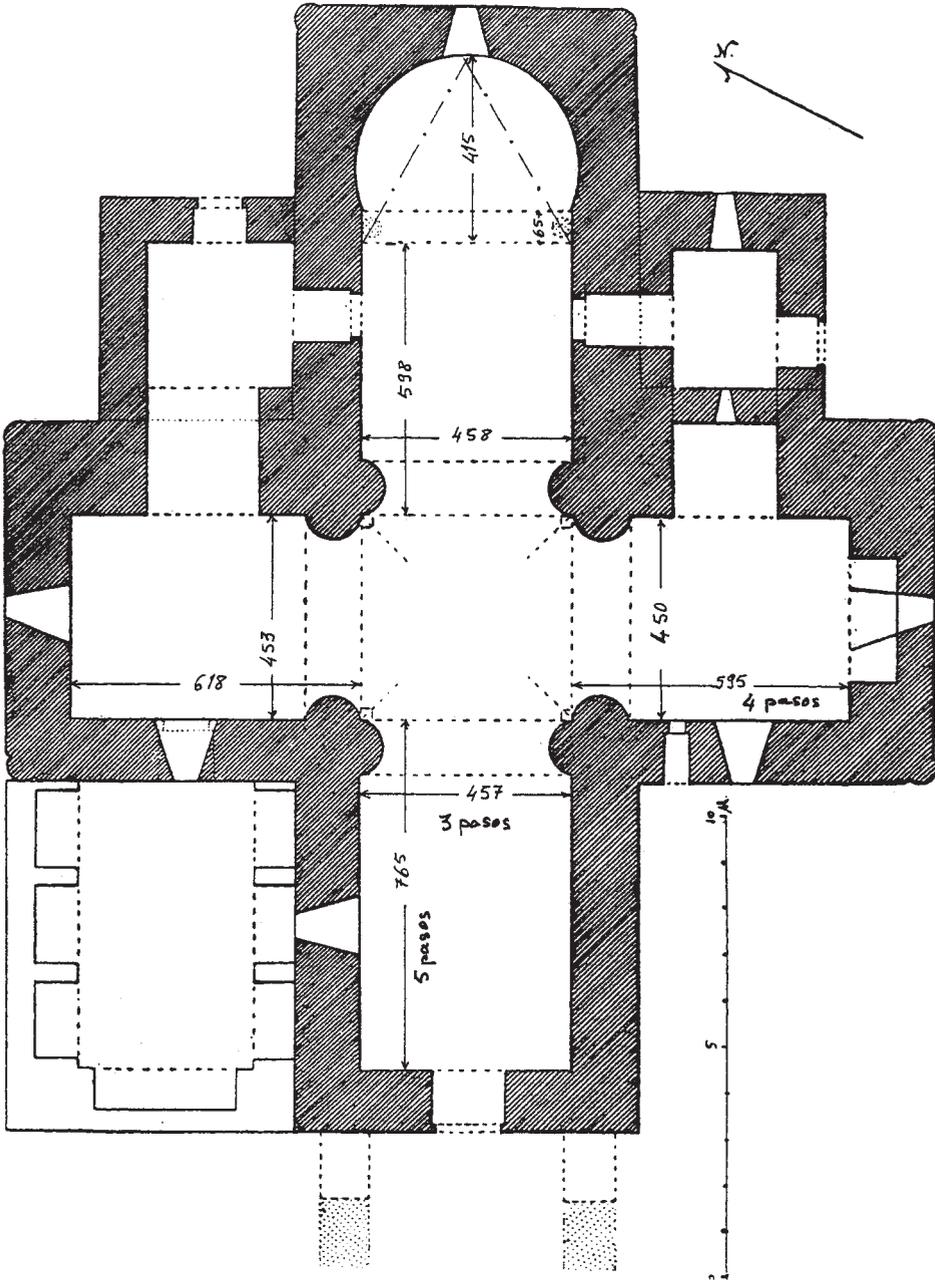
Santa María de Melque. Medidas sobre la planta de M. Gómez Moreno.
